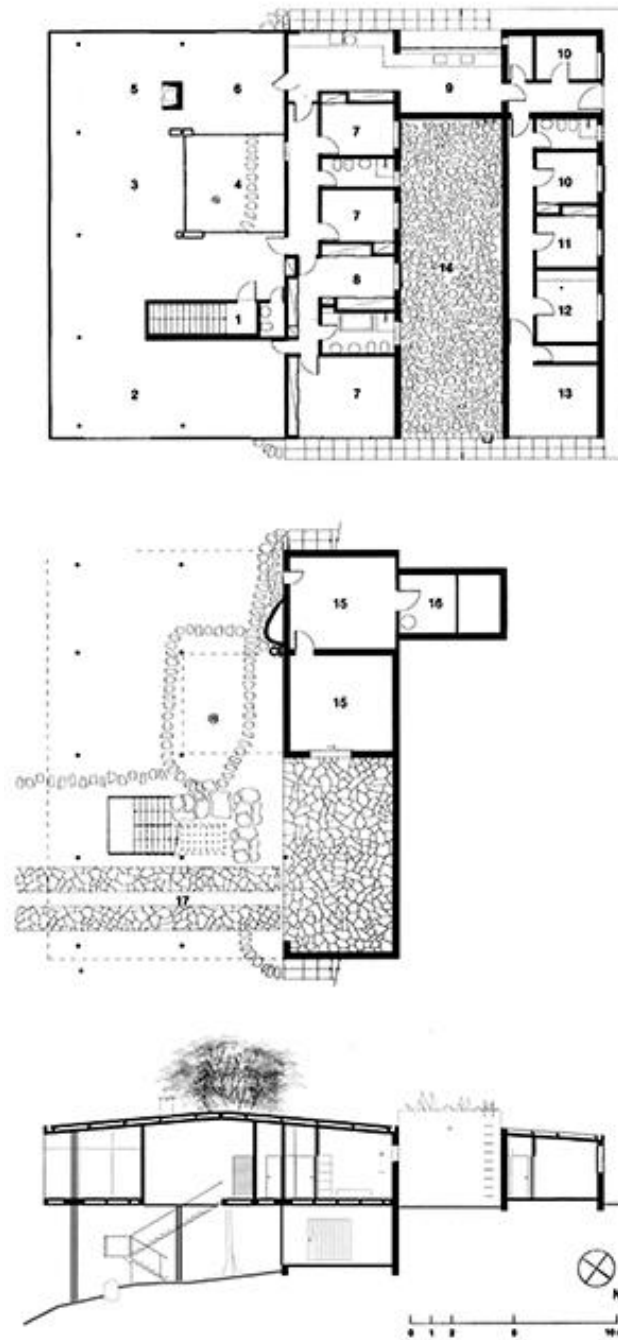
Desenho de Lina Bo Bardi – Planta da Casa de Vidro, São Paulo, 1950.
